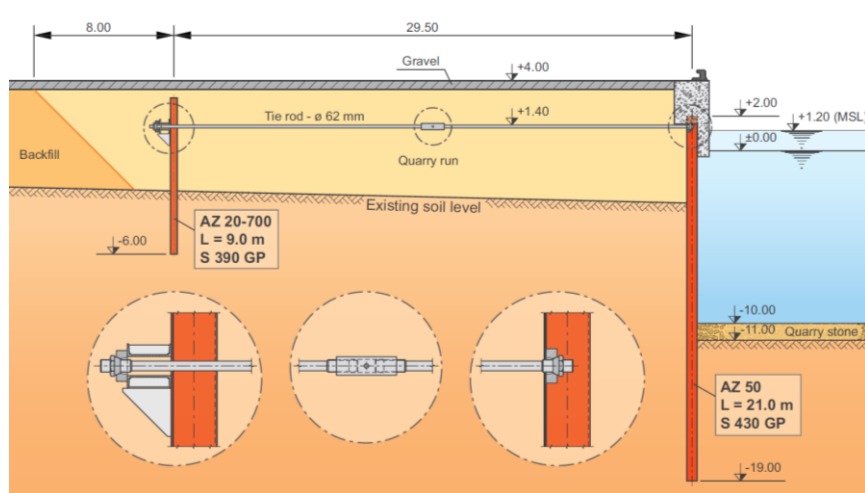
Secção transversal da estrutura do cais (retirado de www.arcelormittal.com/sheetpiling.com)
